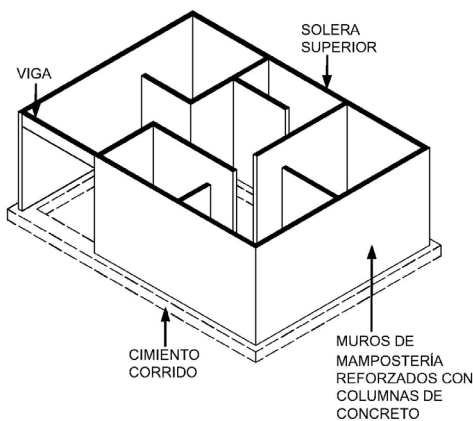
Se rematan con soleras superiores que sirven de anclaje a las cubiertas.
